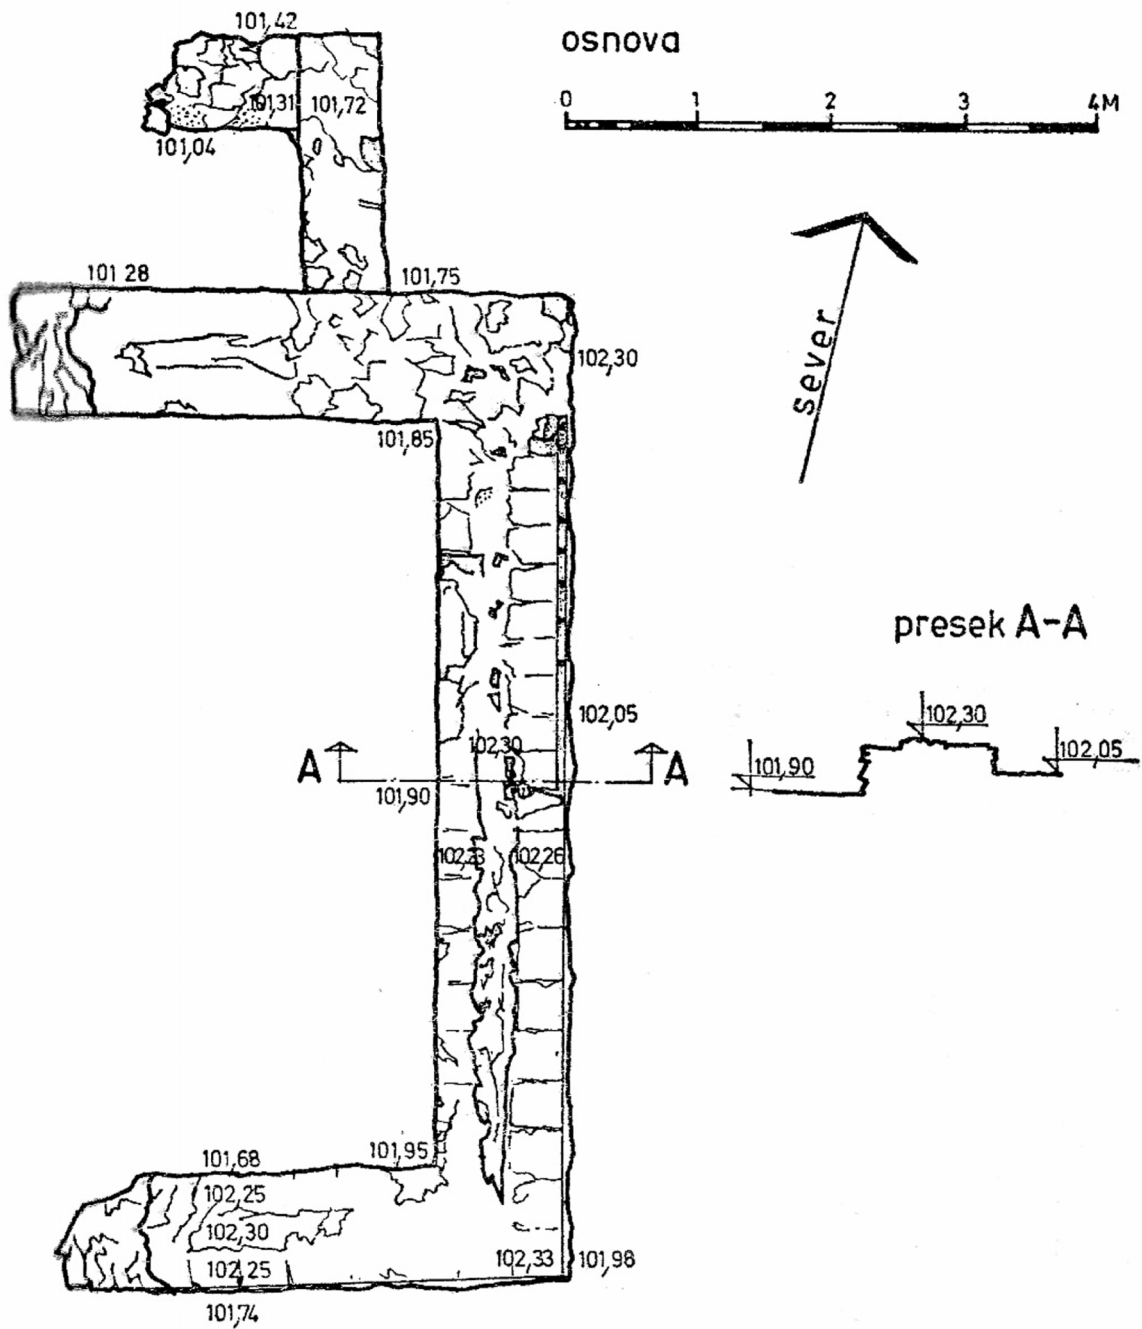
/10 Le plan et la coupe de specula, O. Брукнер, 1976
